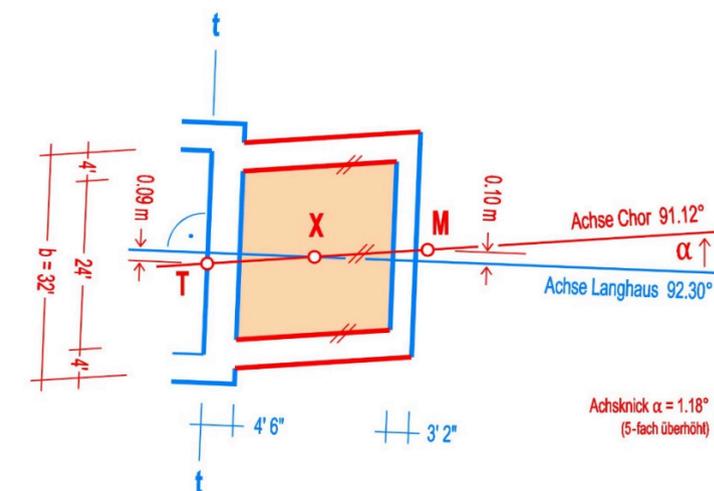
Pfarrkirche Schöngrabern, Geometrie Chorquadrat (Grundriss Parallelogramm), Orientierung in Längsrichtung nach Achse Chor (rot) und in Querrichtung normal auf Achse Langhaus (blau). Punkte T (Mitte Triumphpforte) und M (Mittelpunkt Apsis) liegen auf der Achse Chor und weichen deshalb von der Achse Langhaus um 9 cm nach Süden bzw. um 10 cm nach Norden von ihr ab (Achsknick 5-fach und Wände ohne Sockel dargestellt).
